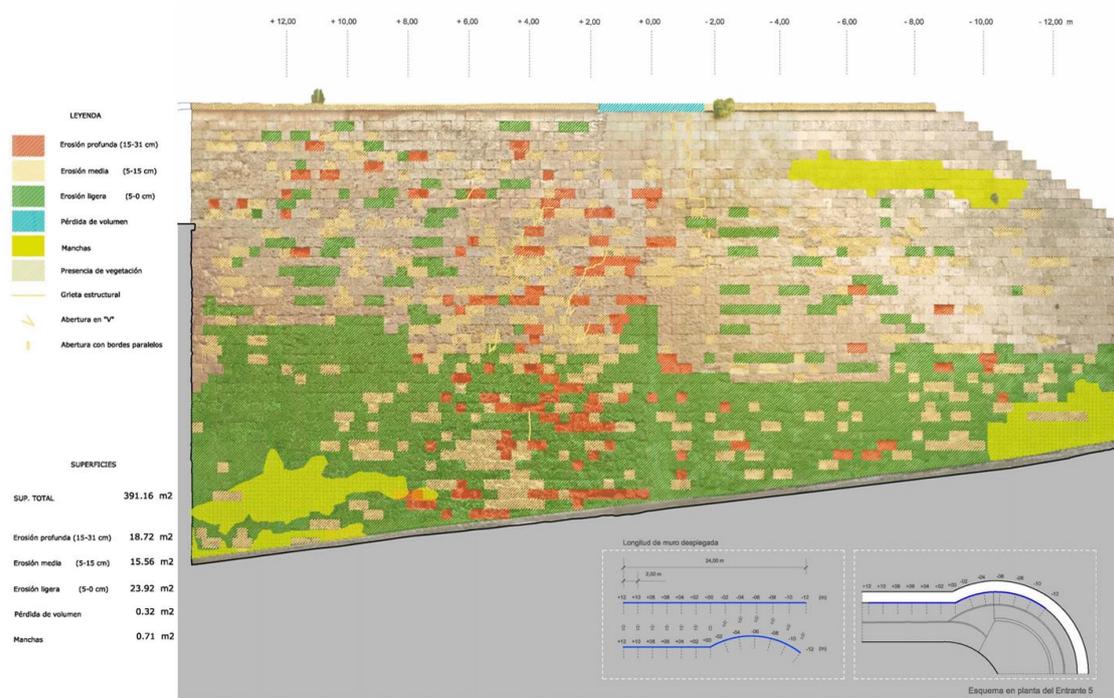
Fotoplano alzado Entrante 5 con cuadro y estudio patológico. Proyecto de ejecución.
